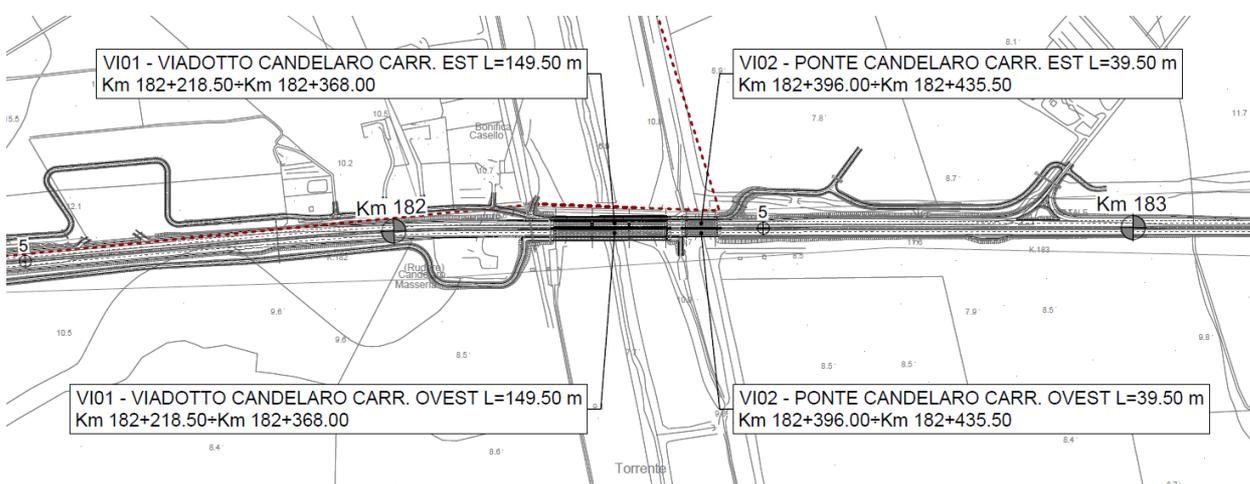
VI01 Viadotto Candelaro e VI02 Ponte Candelaro (stralcio da elaborato T00EG00GENPL01A – Planimetria generale allegata al Progetto Definitivo)
